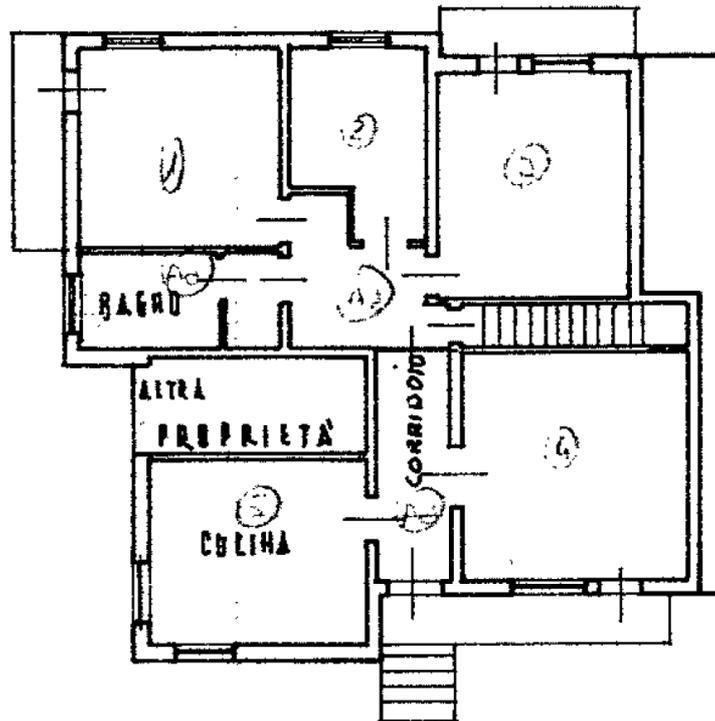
Planimetria catastali dei beni (sub. 1 – p.t.).
